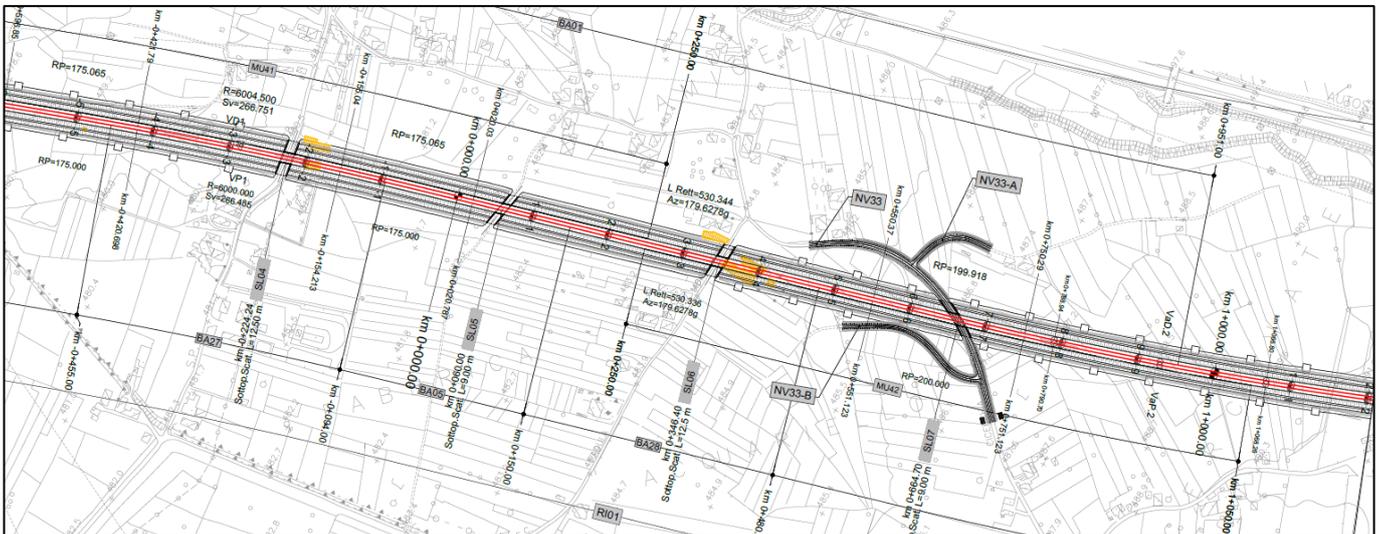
Planimetria con individuazione della nuova viabilità NV33
